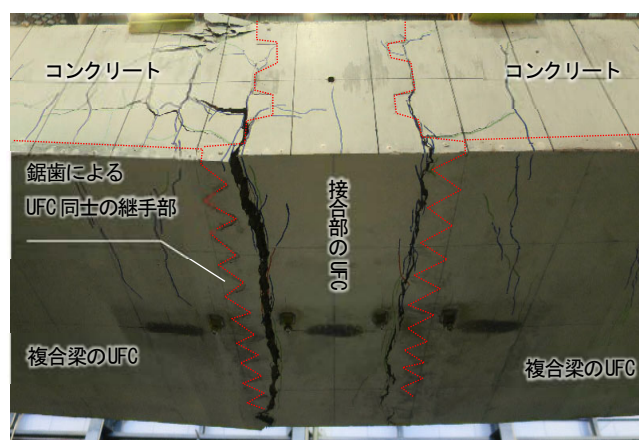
破壊時 接合部近傍のひび割れ状況
